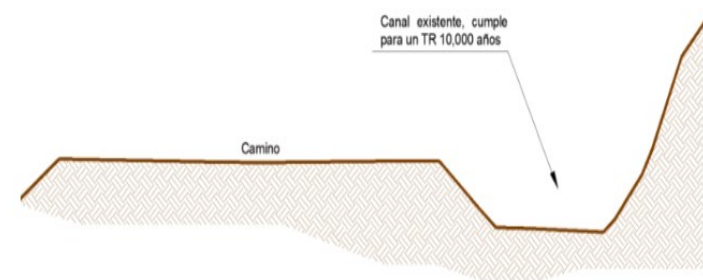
Sección 2 del canal de desvío 2 vista norte a sur
